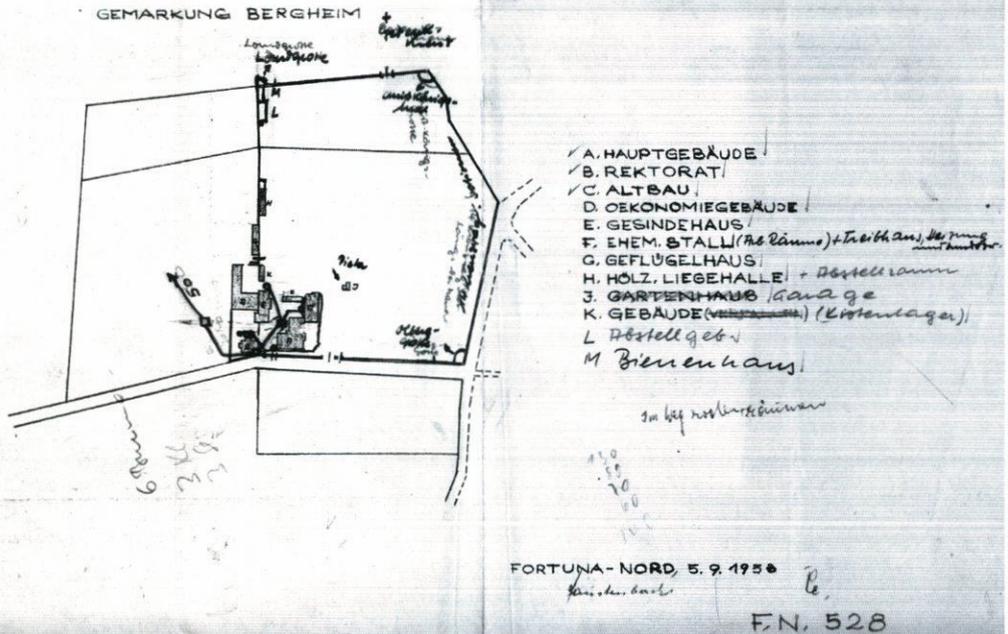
Lageplan 1958 (Quelle: RWE-Archiv Köln).
